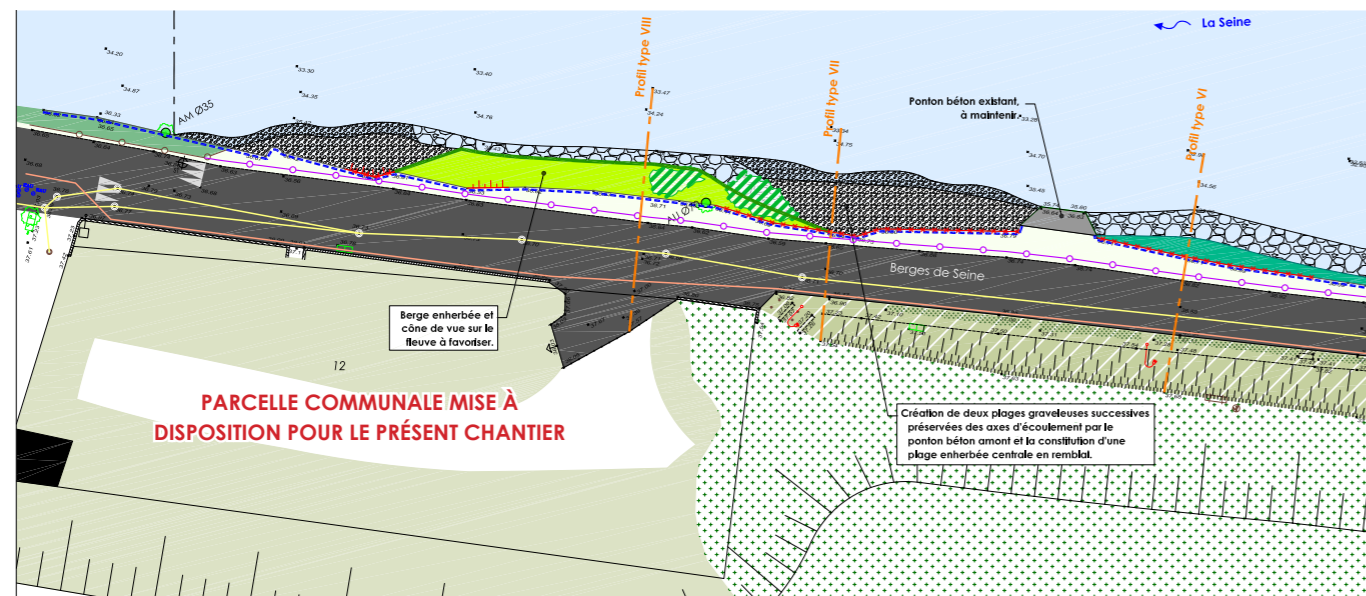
Extrait du plan de situation détaillée localisant la parcelle dédiée aux installations de chantier lors de la mise en œuvre des interventions projetées (conception Biotec).
